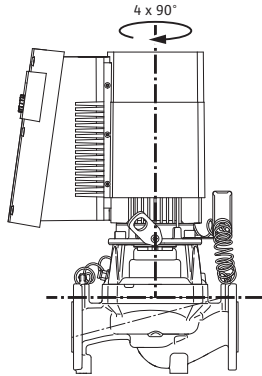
Dikey motor mili ile izin verilen montaj konumları
